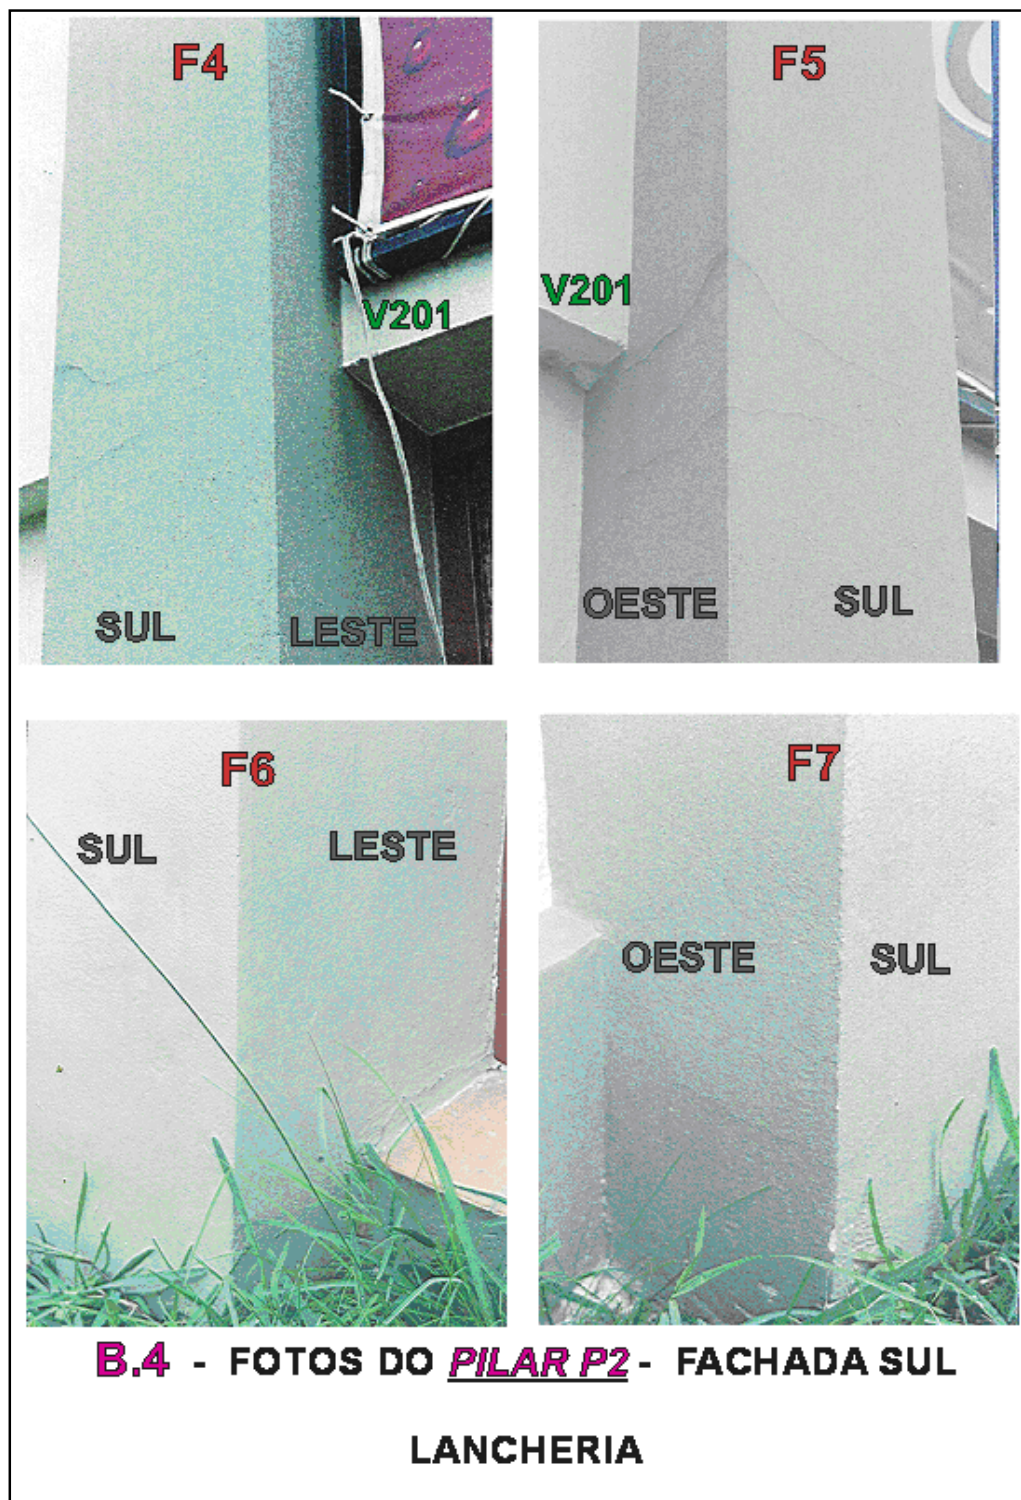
Fotos de fissuras manifestando-se no pilar P2, fachada sul da lancheria (ISAIA, 2001, p. 47)
